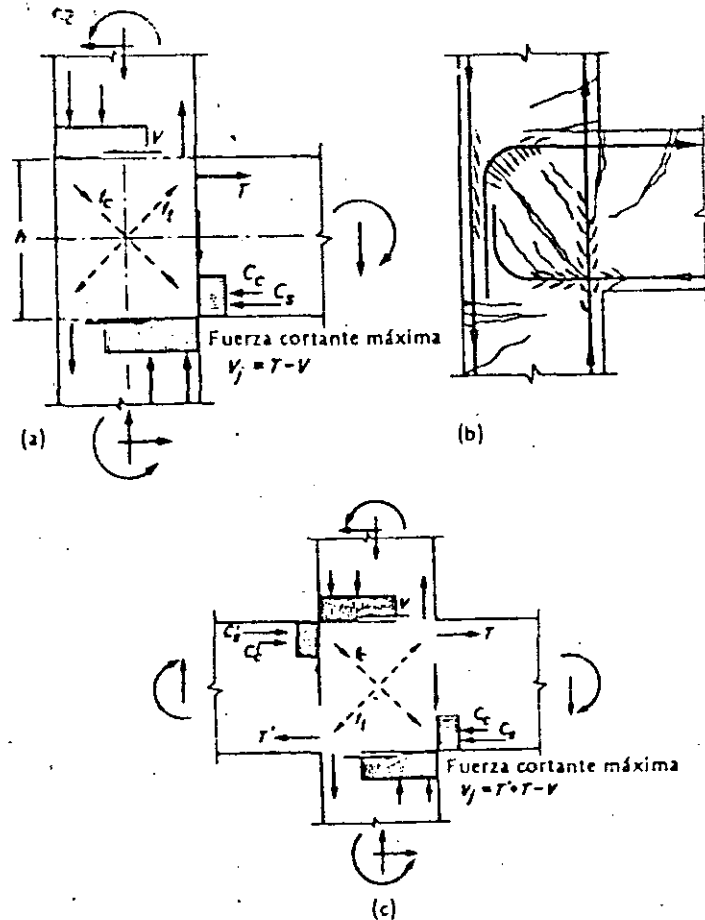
Juntas viga-columna del marco con carga sísmica. a) Acciones y resultantes de los esfuerzos en la junta exterior viga-columna; b) configuración del agrietamiento y fuerzas de adherencia en la junta exterior viga-columna, c) acciones y resultantes de los esfuerzos en una junta interior viga-columna.
